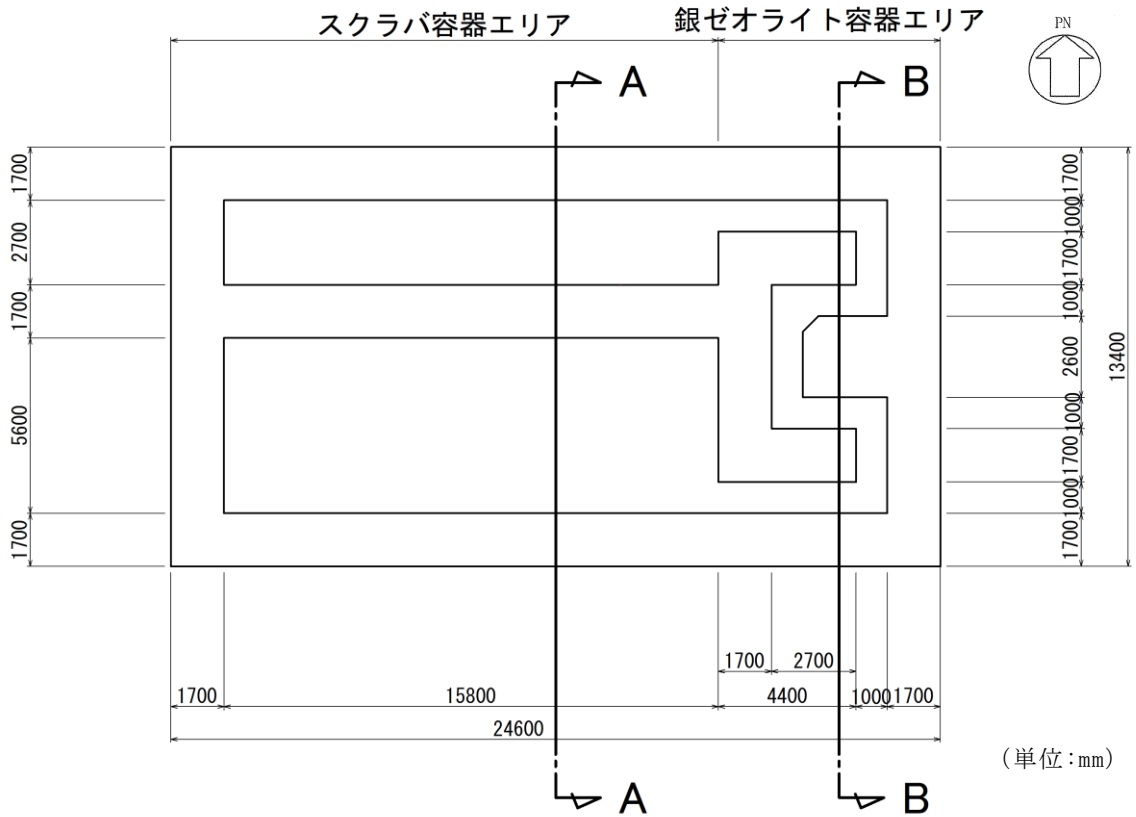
第1ベントフィルタ格納槽 評価対象断面位置図
